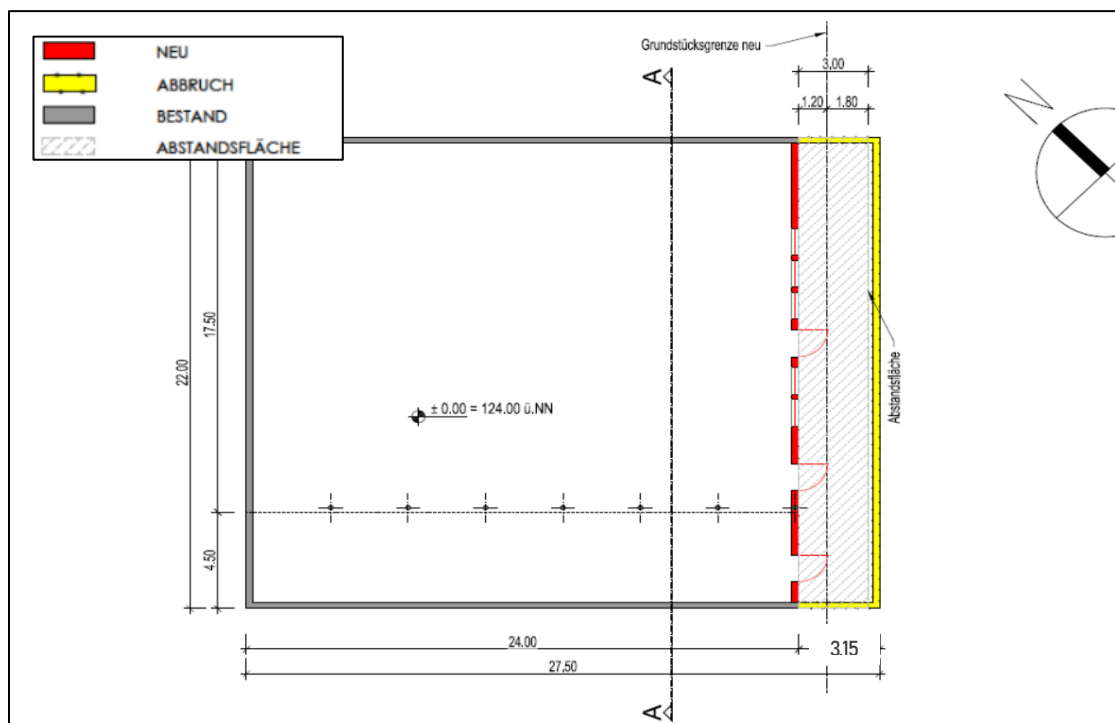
Geplanter Rückbau und Wiederaufbau der südöstlichen Außenwand der benachbarten Scheune (Quelle: Scalaplan Hamburg, Stand 07/2019)
